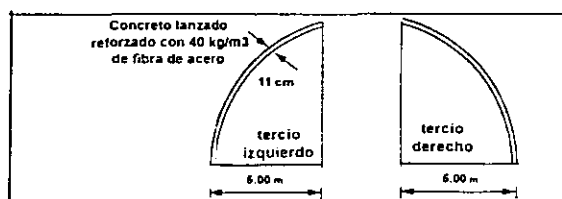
Colocación de concreto reforzado con fibras de acero, con espesor de 11 cm.
